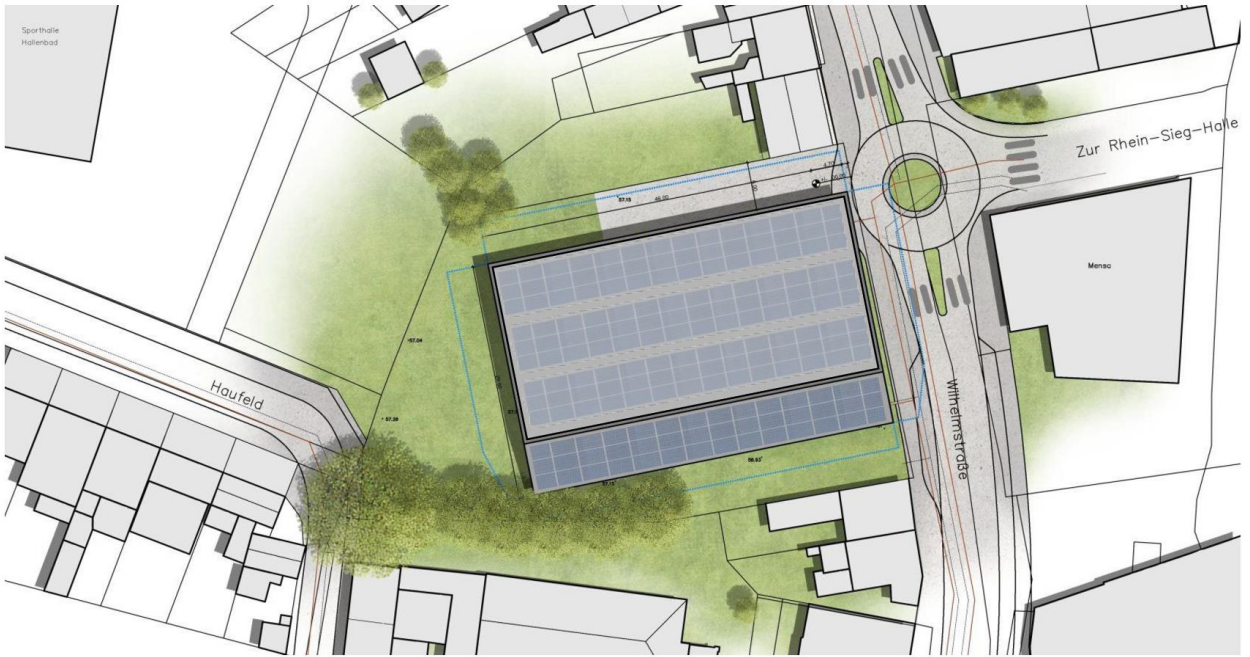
Lageplan Option 2 (Quelle: Architekturbüro heinlewischer, Köln)
